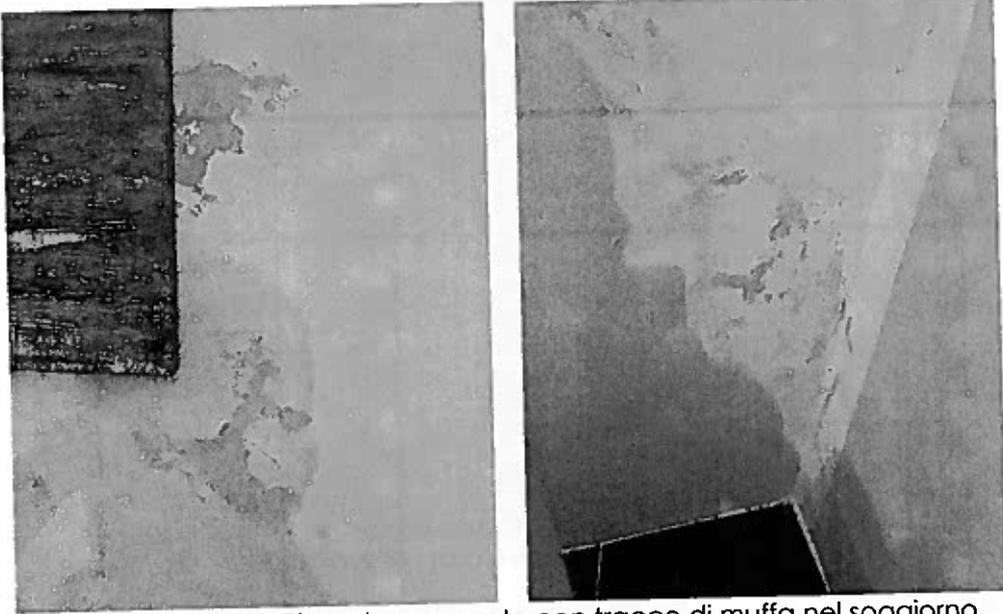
e 29A – Piano terra, parete con tracce di muffa nel soggiorno
